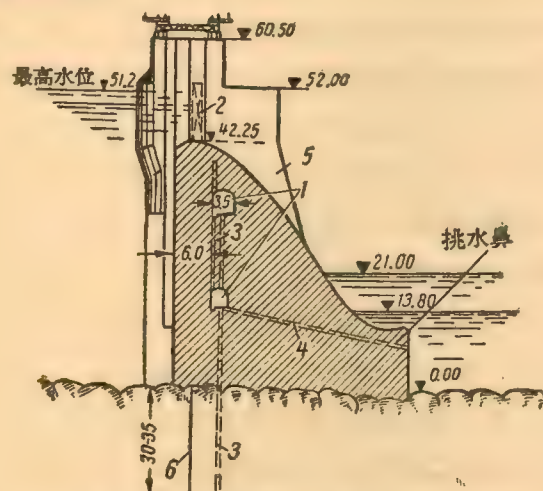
頂上裝有閘門的混凝土壩的橫斷面
